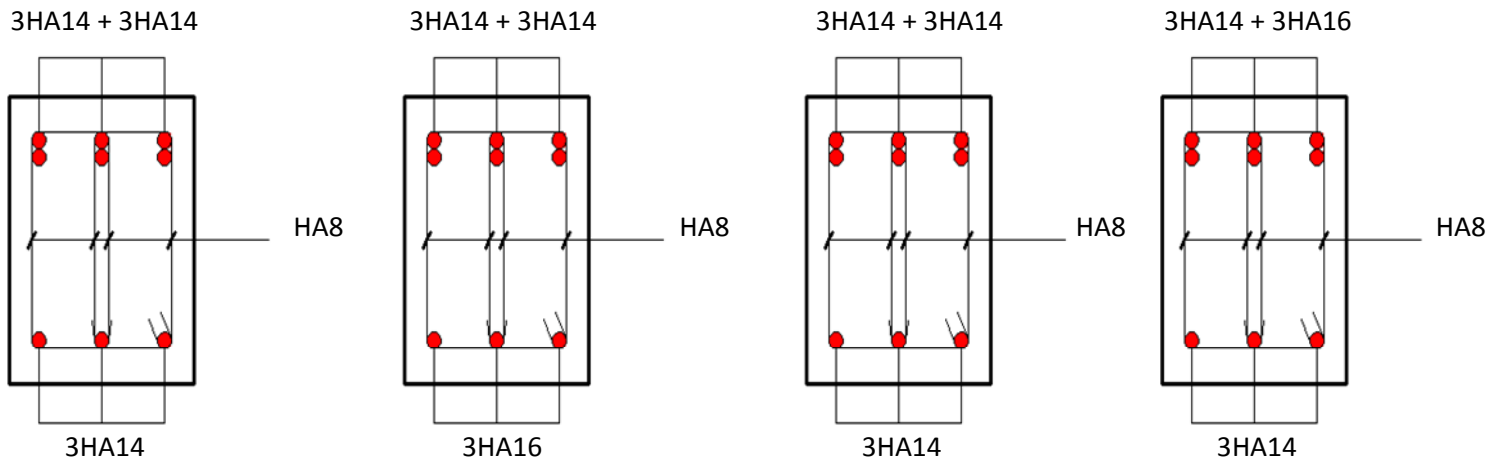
Coupes verticales des poutres principales adhérentes aux voiles au niveau des travées
